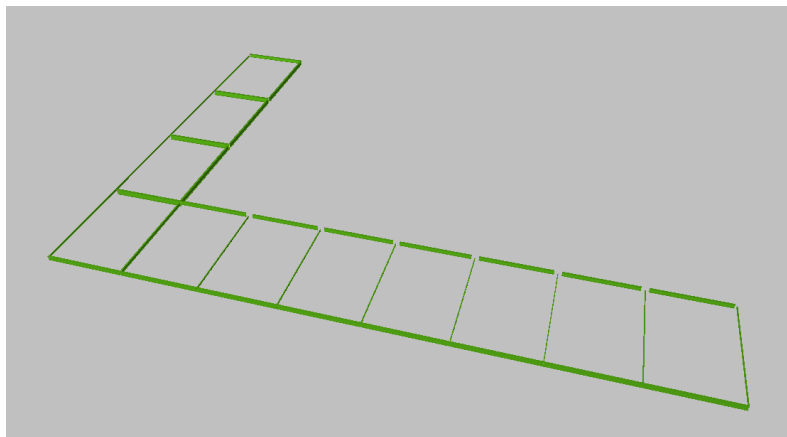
Esquema forjado segunda planta. Fuente CYPE 3D
